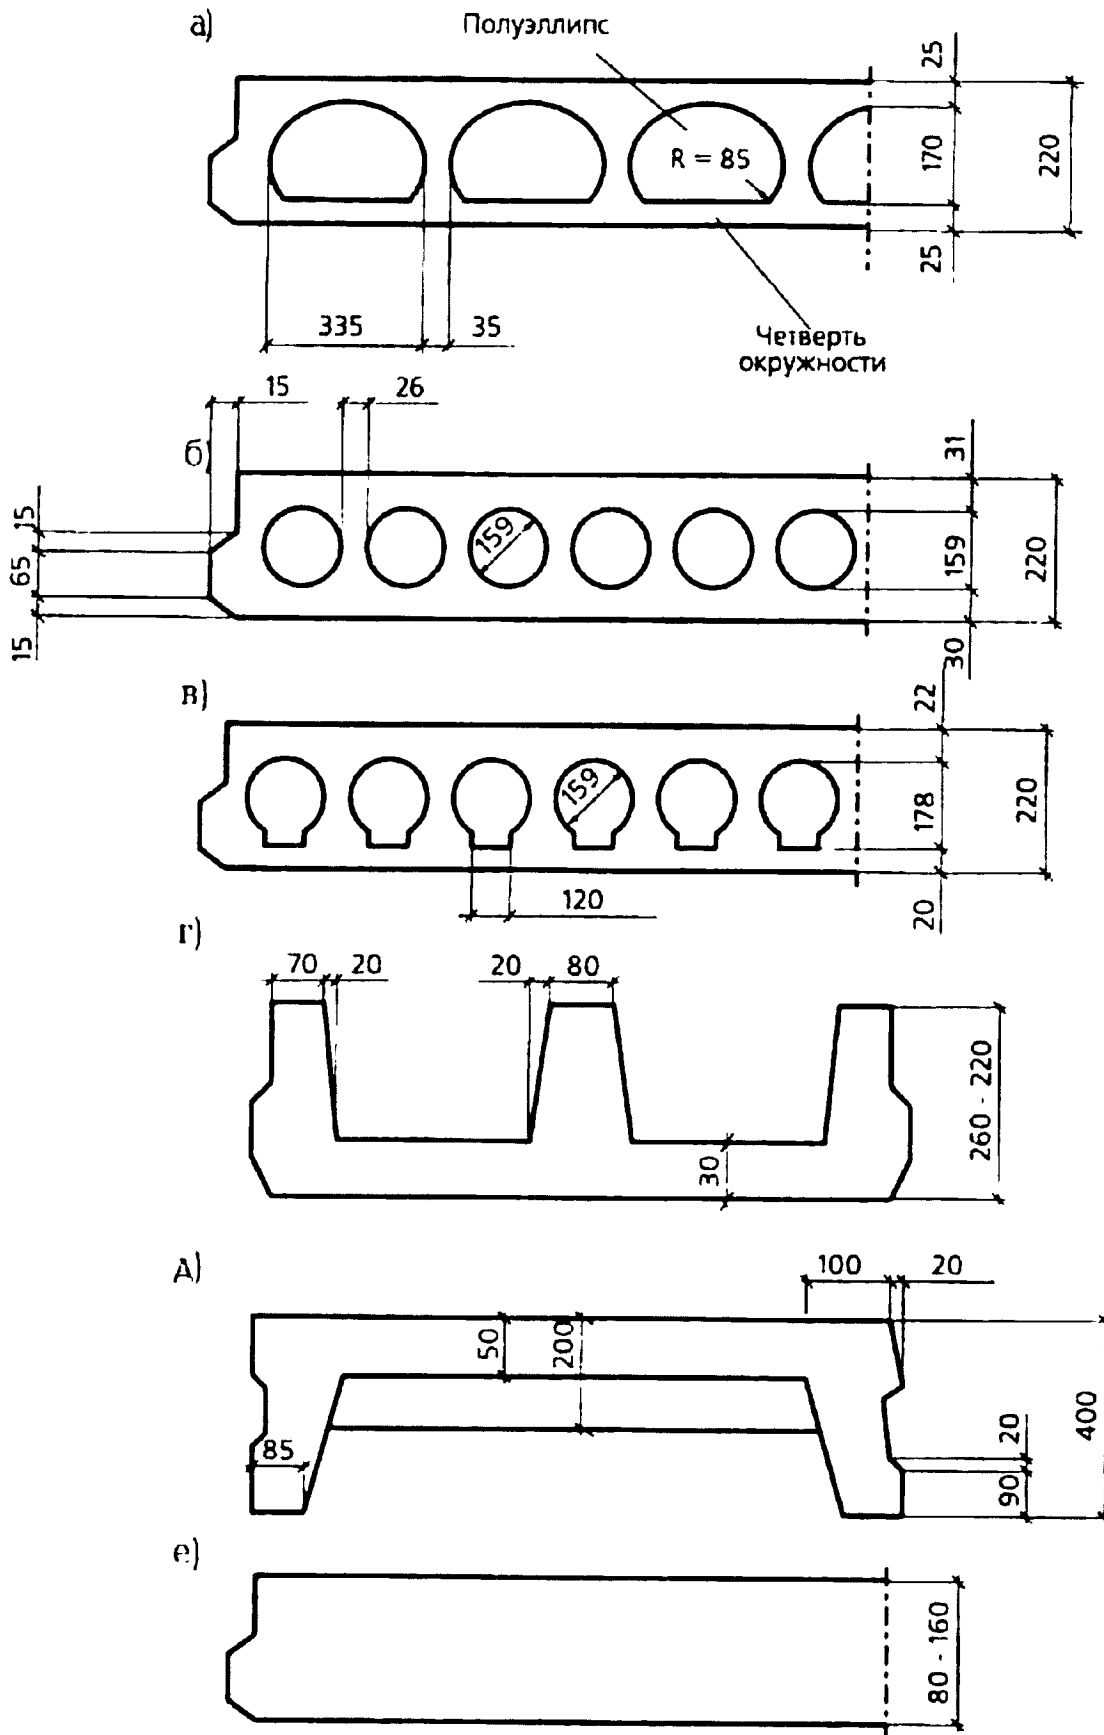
Формы поперечного сечения плит перекрытий: а - с овальными пустотами; б - с круглыми пустотами; в - с вертикальными пустотами; г - ребристые с ребрами вверх; д - ребристые с ребрами вниз; е - сплошные
